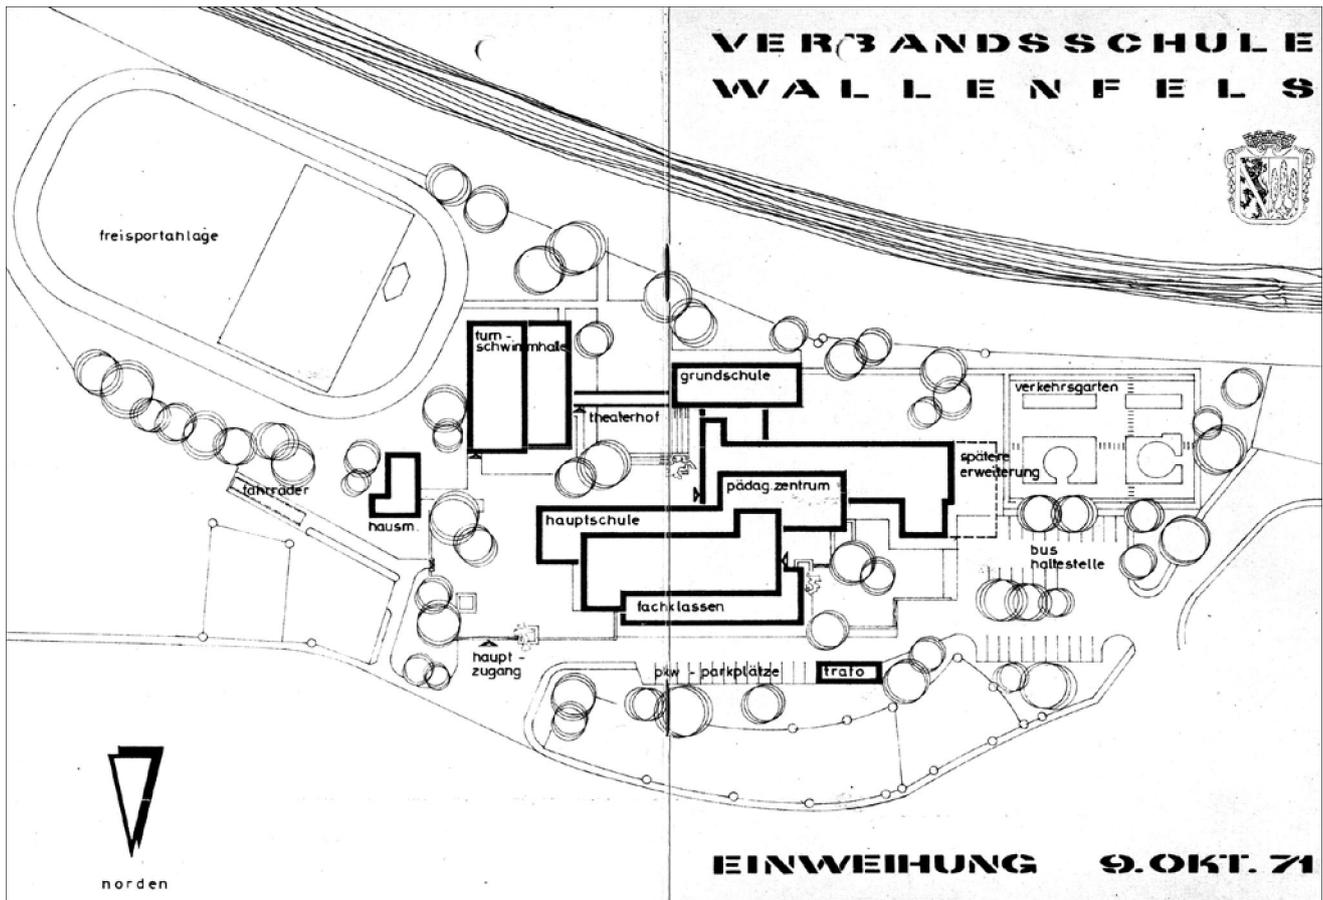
Wallenfels, Verbandsschule, Lageplan
